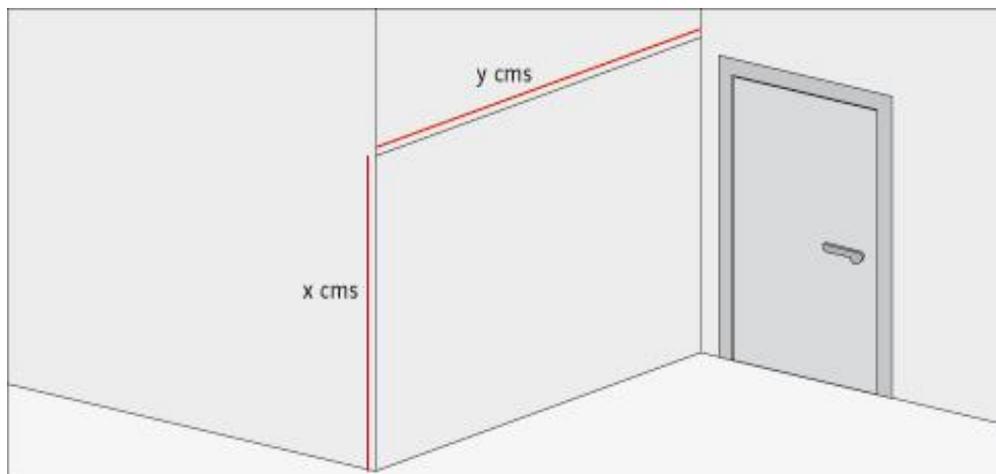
Se especifica y se limpia el área donde se van a colocar las fachaletas
